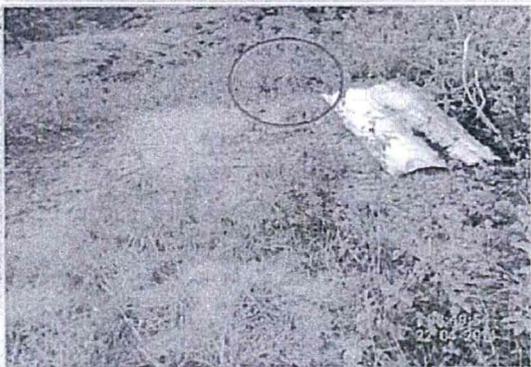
E: 0460918 N: 9622265 / Drenaje de gases de relleno sanitario clausurado.
